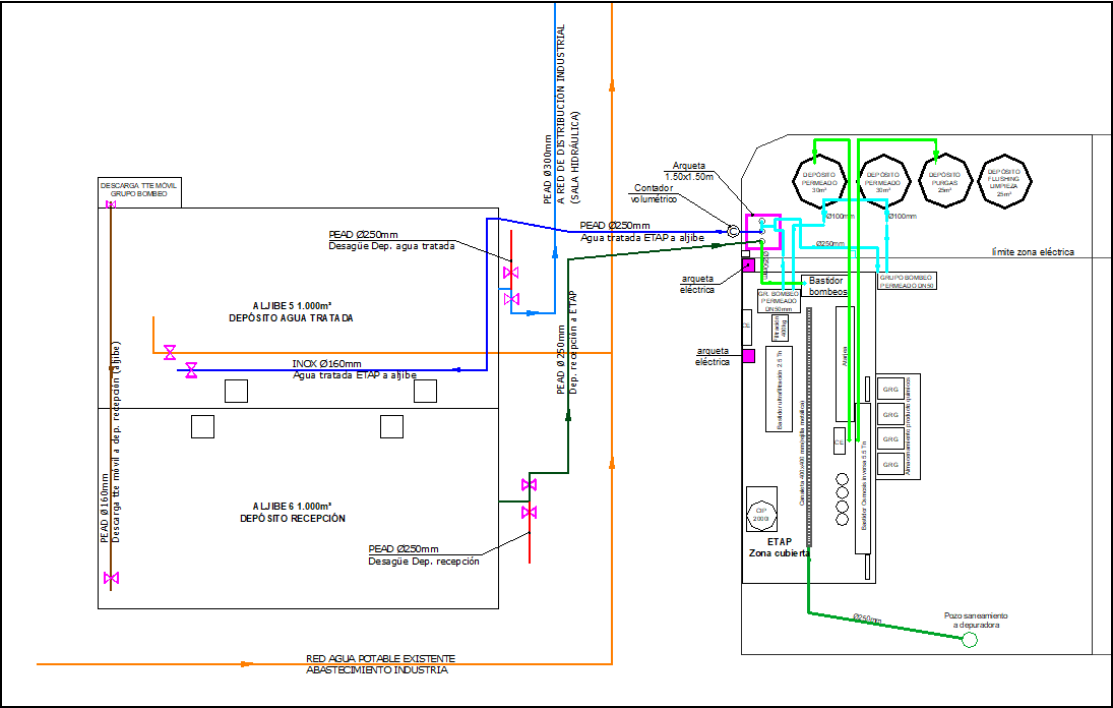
Planta general de PLANTA POTABILIZADORA COVAP.
